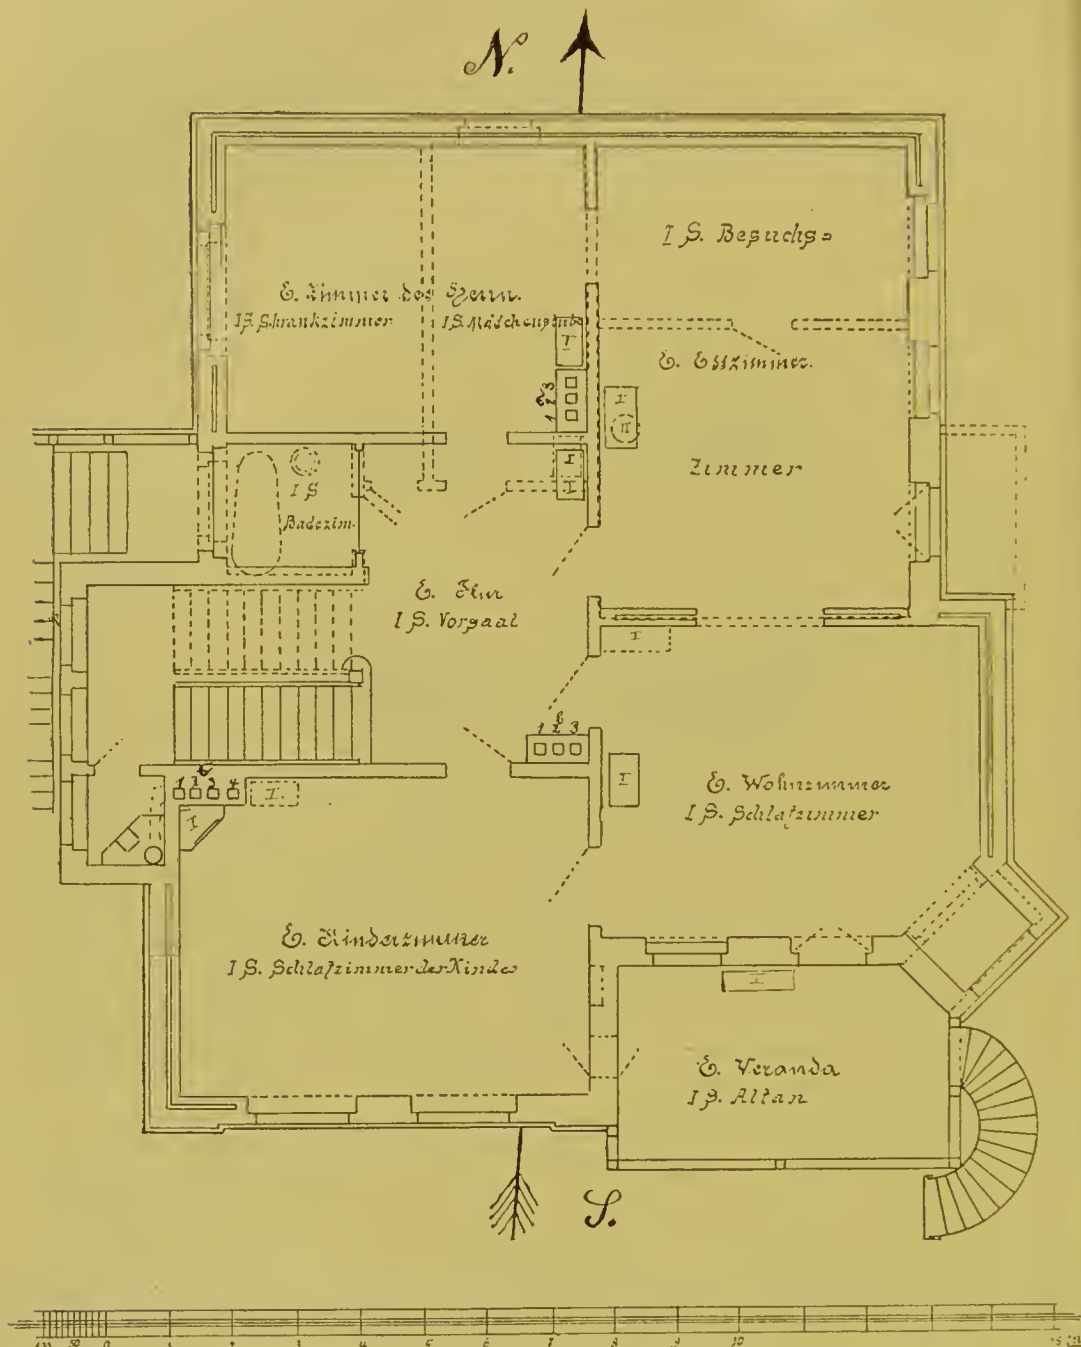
Grundriss eines Privathauses in einem Villenviertel Jenas. Die mit E bezeichneten Räume liegen im Erdgeschoss (Hochparterre), die mit IS bezeichneten und die gestrichelten Zimmerungrenzungen und Thüren im Obergeschoss. a1 Schornstein der Localheizung der Gastzimmer. a2 Schornstein der Centralheizung. a3 Ventilations-schacht f. d. Herrenzimmer. b1 Ventilationssehlot f. d. Kinderschlafzimmer. b2 Ventilationssehlot f. d. Wohnzimmer. b3 Ventilationssehlot f. d. Schlafzimmer. e1 Ventilationssehlot f. d. Abfallrohr und die Tonne. e2 Kuchenschornstein. e3 Ventilationsrohr f. d. Schwadenfang der Küche. e4 Ventilationsrohr f. d. Kinderzimmer. 1 Heizkörper (Bechem & Post) 11 Füllöfen.
